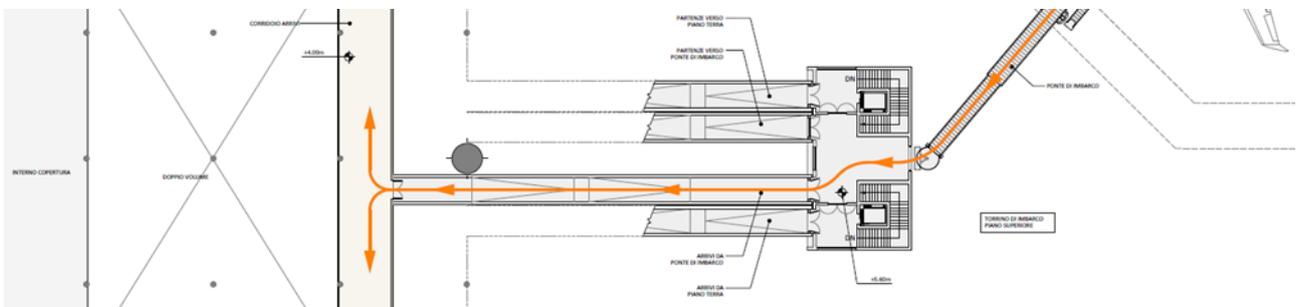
| Schema planimetrico di funzionamento flussi di sbarco da finger a mezzanino
